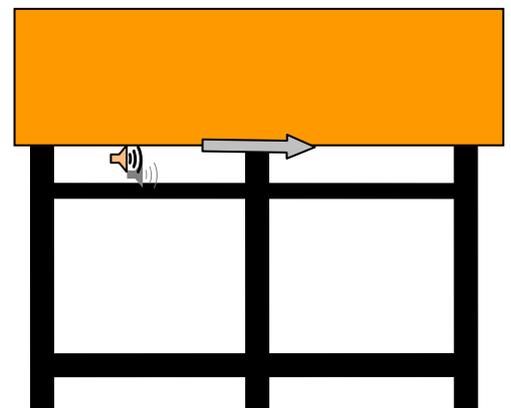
Schéma type d'une réhabilitation de toiture par l'extérieur (avec panneaux sandwich ou panneau isolant thermique support de couverture) en conservant le plafond coté intérieur.
